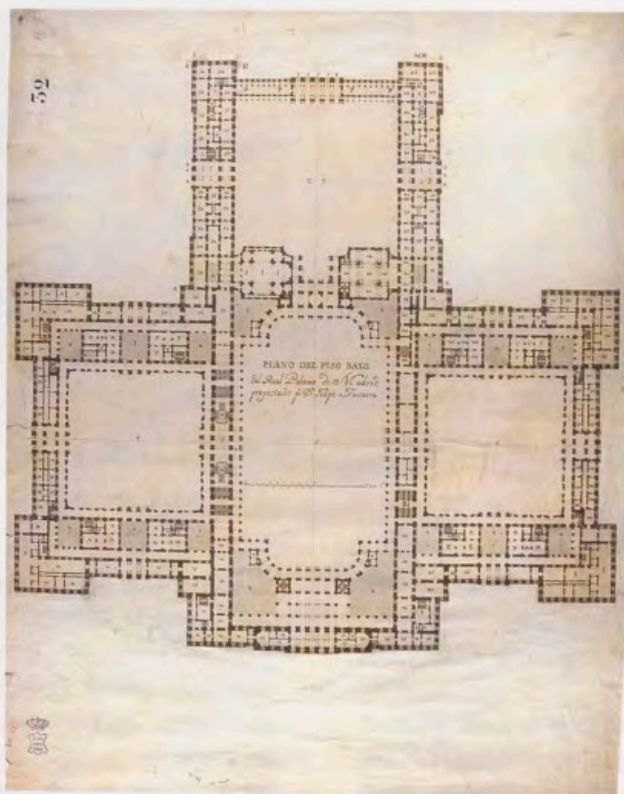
Atribuido a Marcelo Fontón, Proyecto de Filippo Juvarra para el Palacio Real de Madrid: Planta del piso bajo, AGP, Planos, 2.202, Madrid, Patrimonio Nacional.
